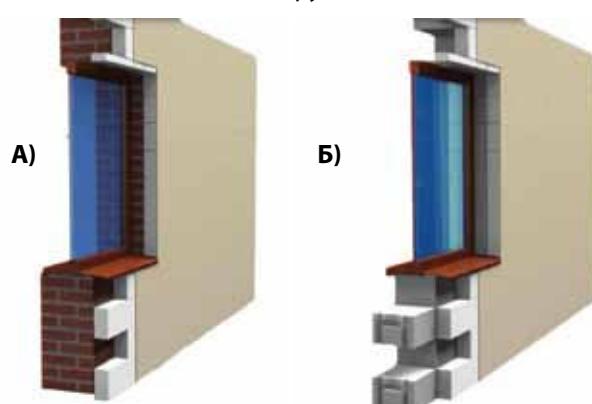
Утепление системой AEROC Energy наружных стен а) из кирпича б) из газобетона
